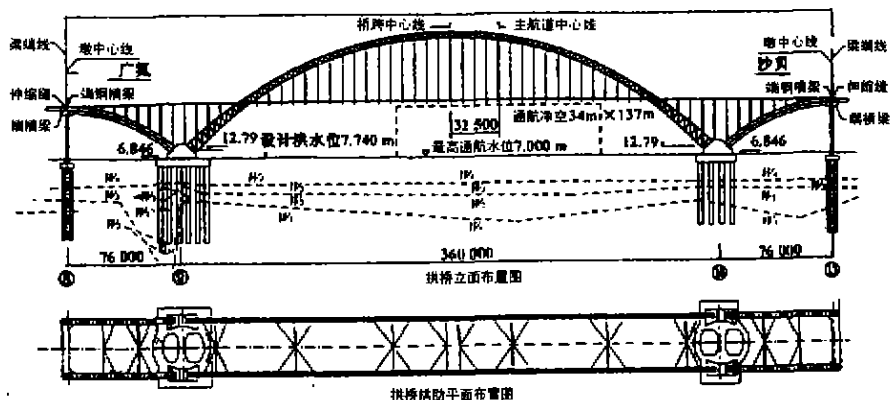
丫髻沙大桥主桥平、立面布置图(单位: mm)
